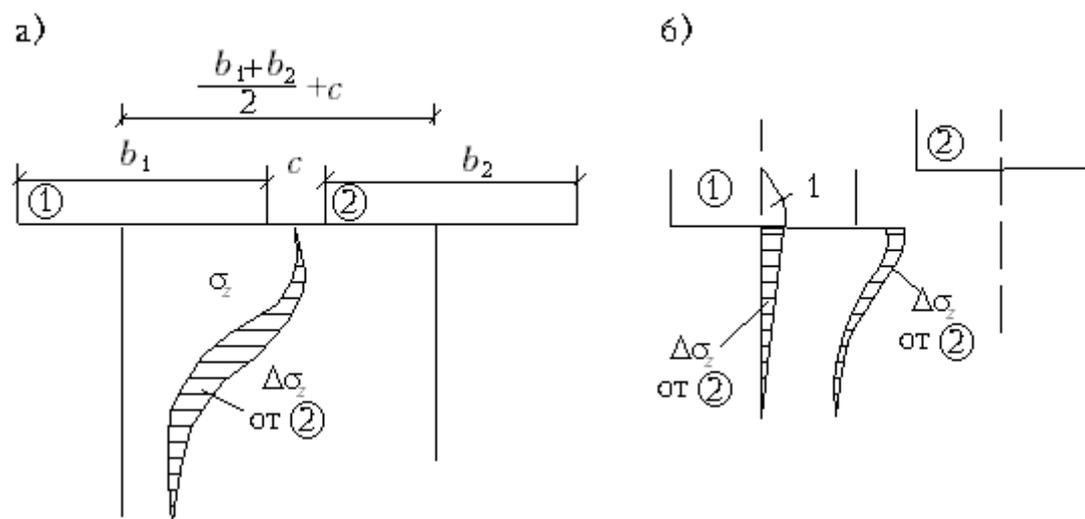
Схемы для расчета осадок при наличии близко расположенных фундаментов: а - фундаменты 1 и 2 находятся рядом на одном уровне; б - фундамент 2 расположен выше, чем фундамент 1
